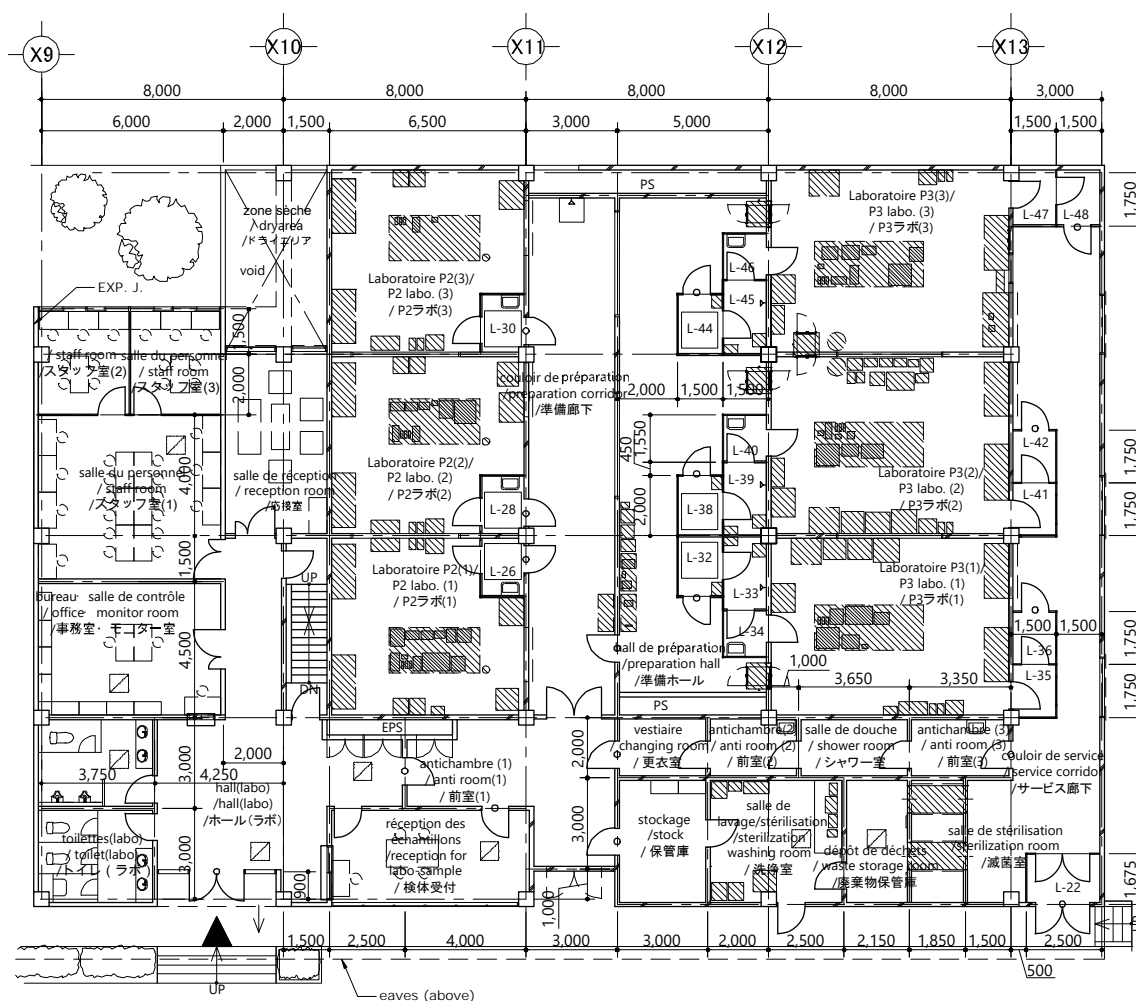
Vue en plan des salles de laboratoires P2 et P3 (avant-projet)
